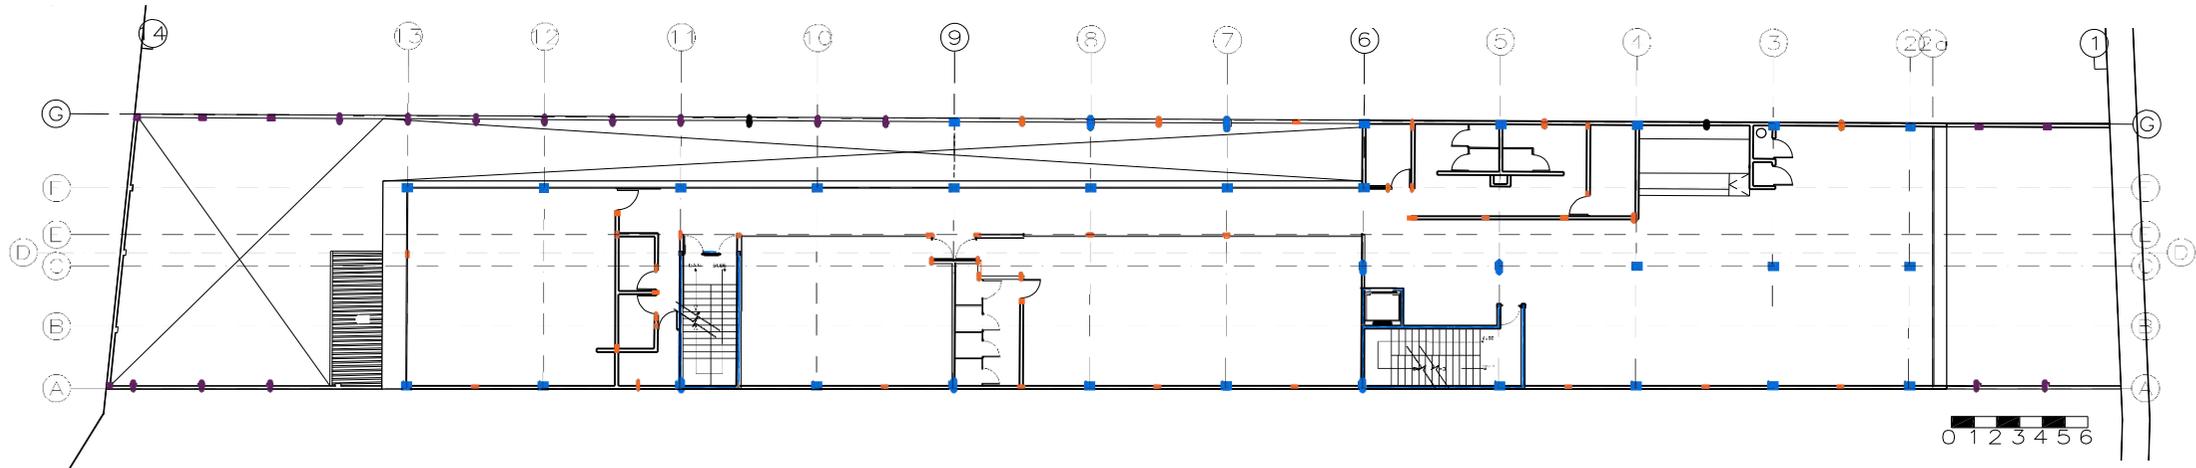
PLANTA ESTRUCTURAL SEGUNDO NIVEL.
